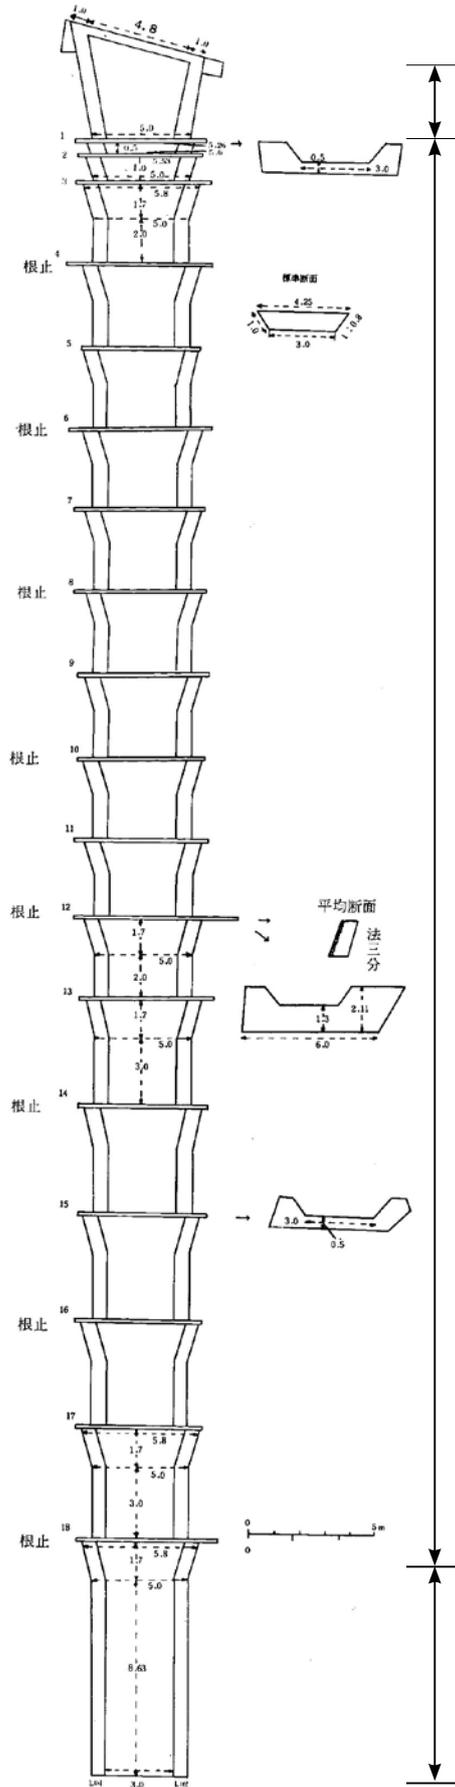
牛伏川本流水路（牛伏川階段工）現況平面図（昭和51年測量「松本砂防のあゆみ」より）
